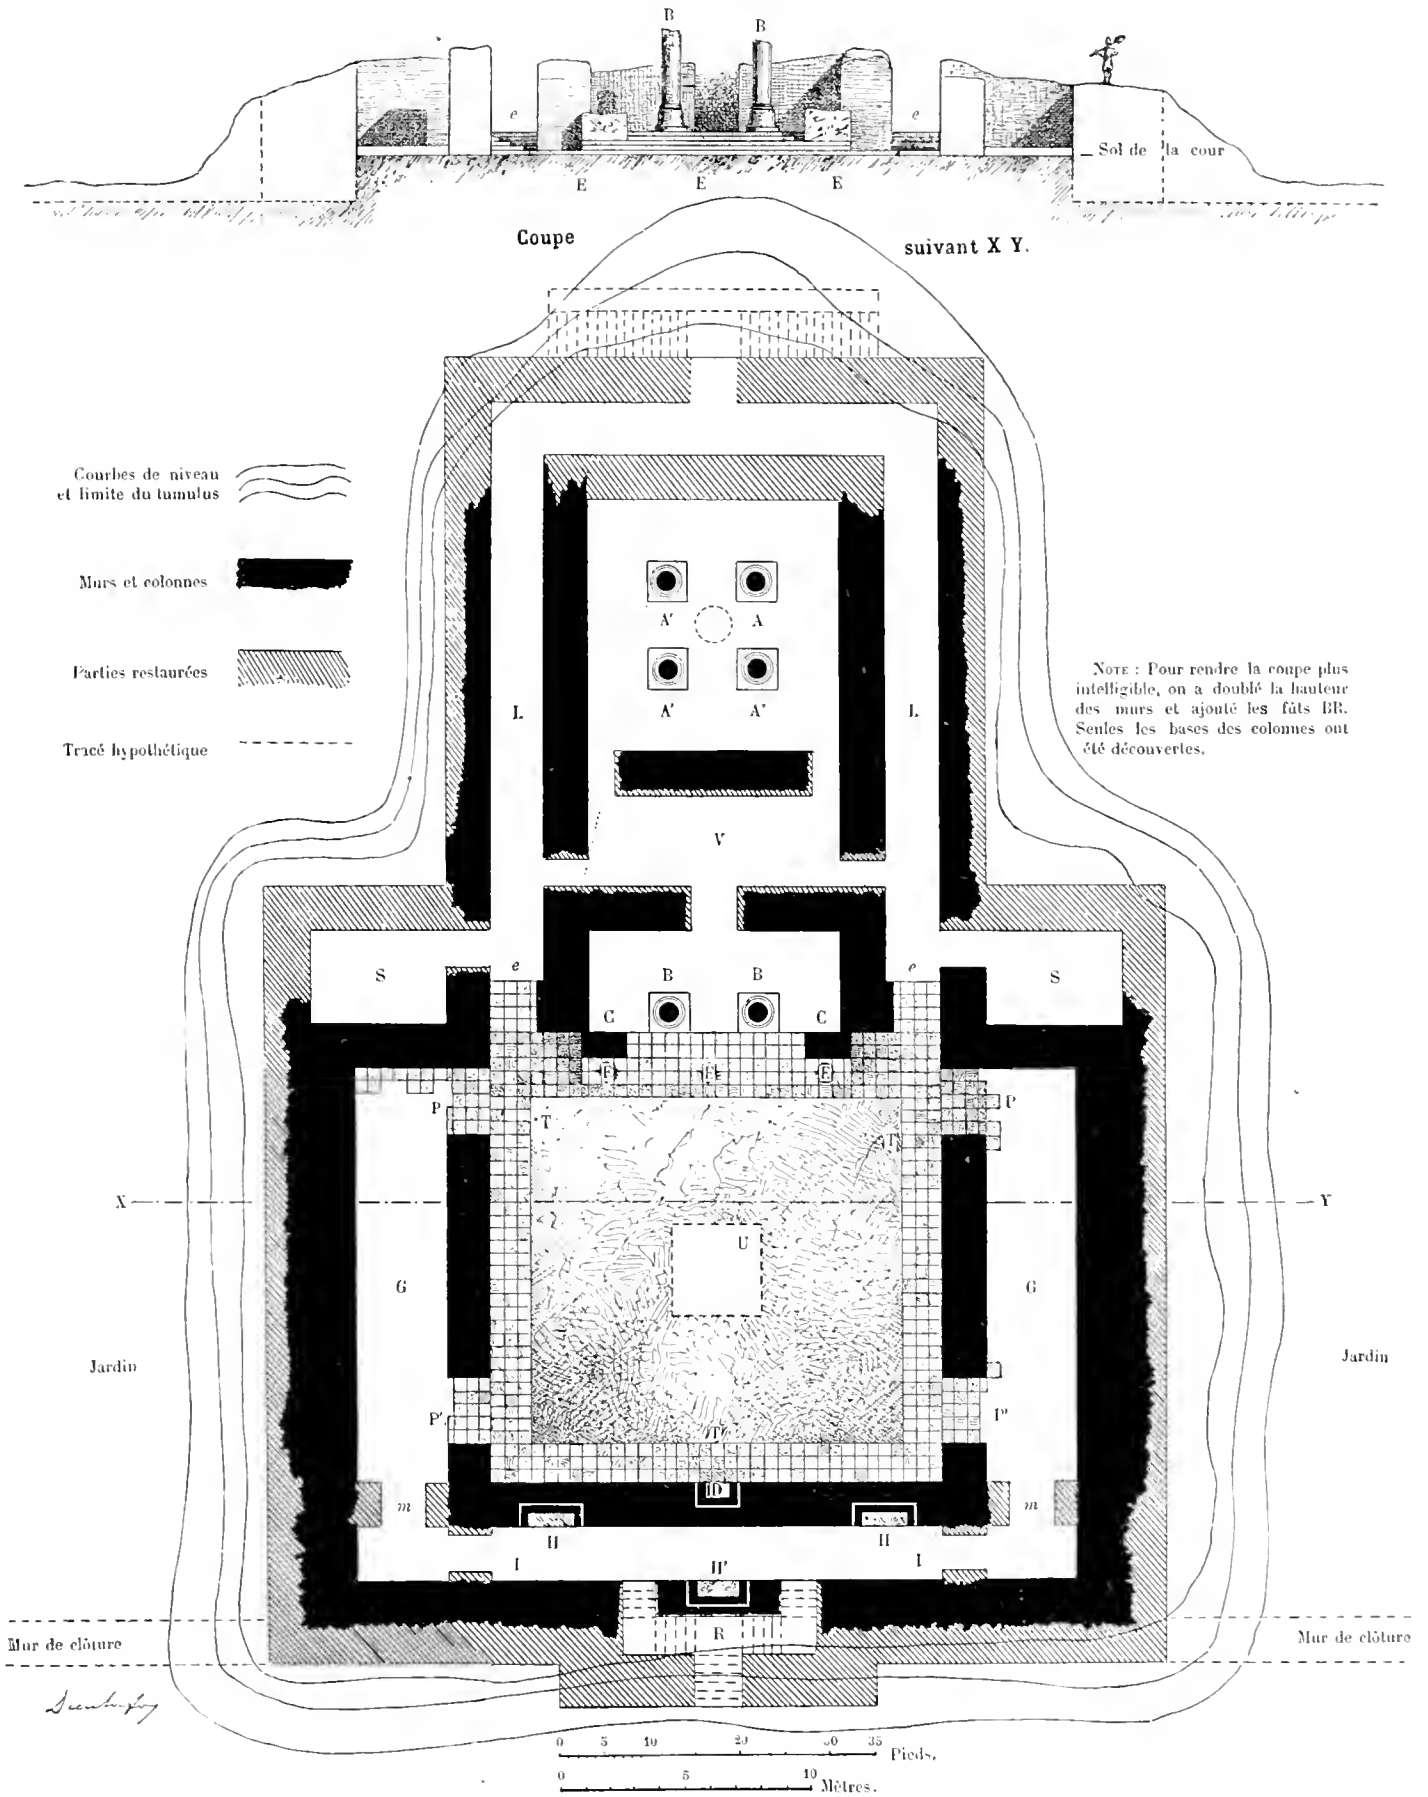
PLAN ET COUPE TRANSVERSALE DE L'AYADANA DE SUSE D'APRÈS LES FOUILLES. — (LES PARTIES COUVERTES DE HACHURES SONT RESTAURÉES.)
